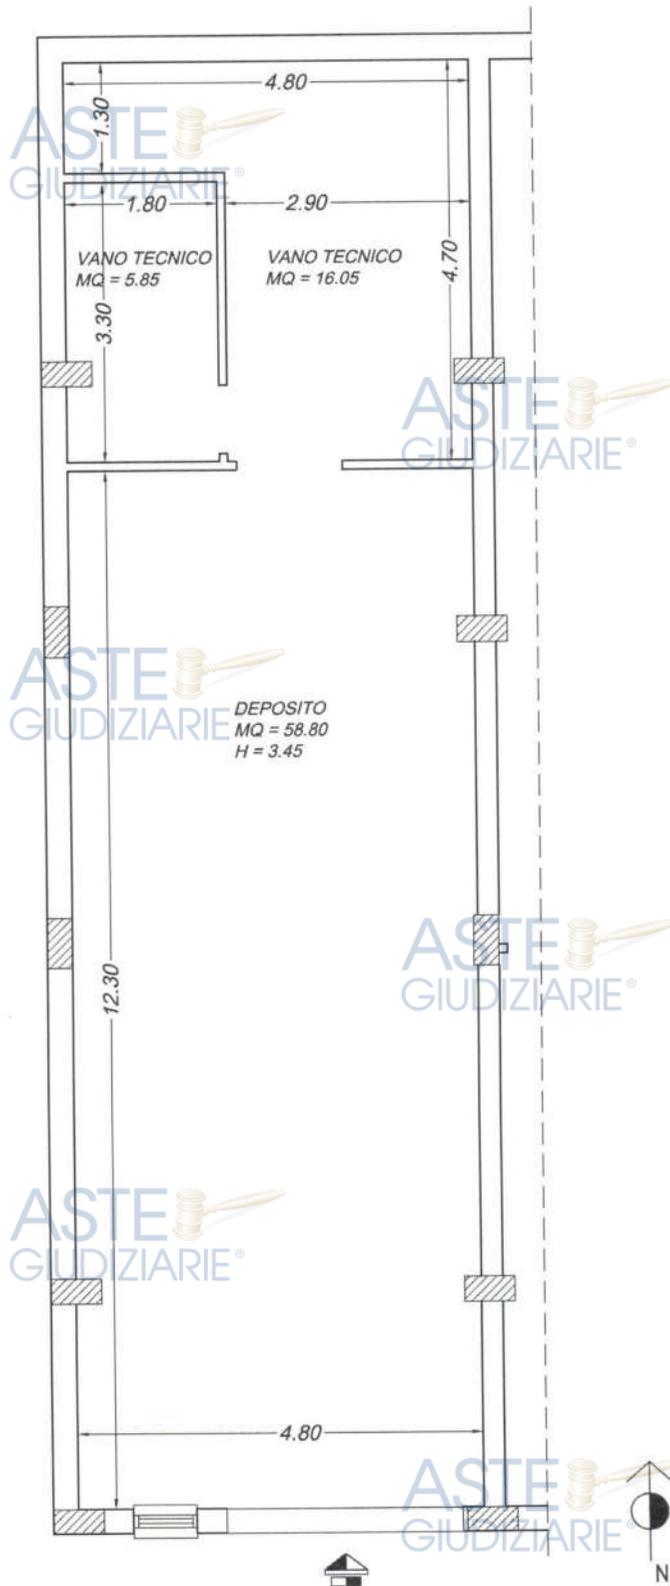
Planimetria Stato di fatto Foglio 23, p.lla 371, sub 6 (ex sub 2) - Piano S1
